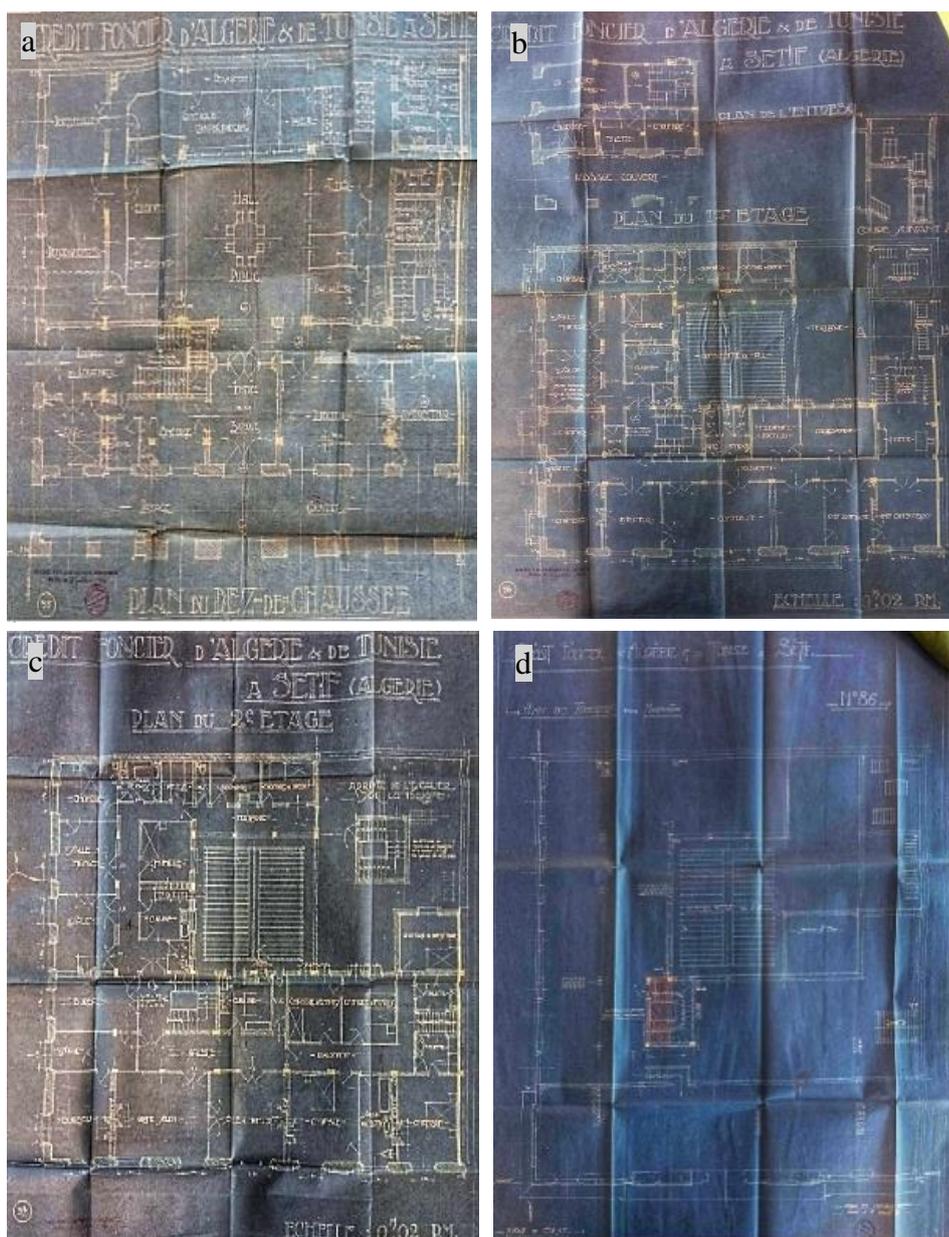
a) plan du RDC ; b) plan de l'entresol et du R+1 ; c) plan du R+2 ; d) plan du terrasse.
